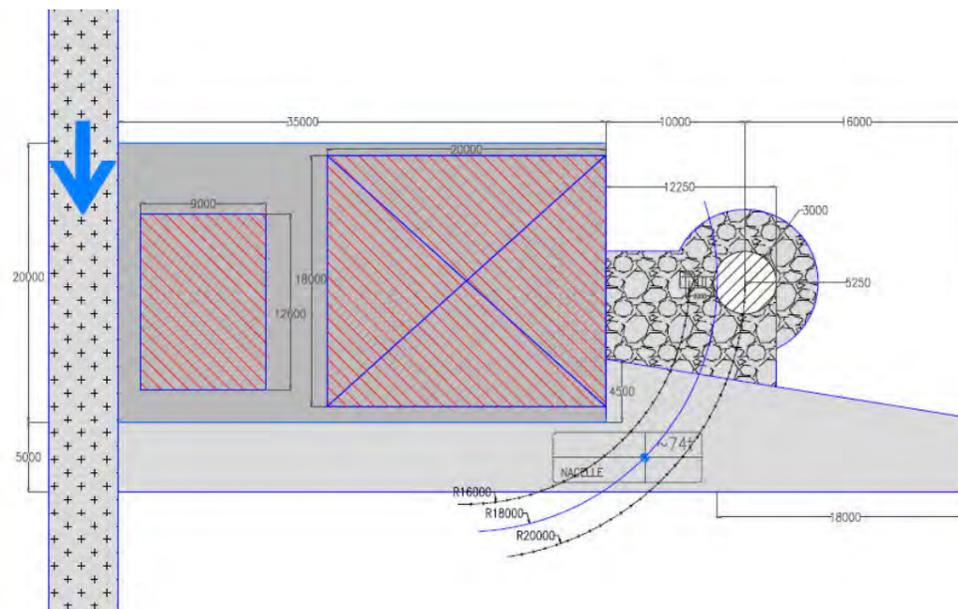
plate-forme perpendiculaire à la piste d'accès
